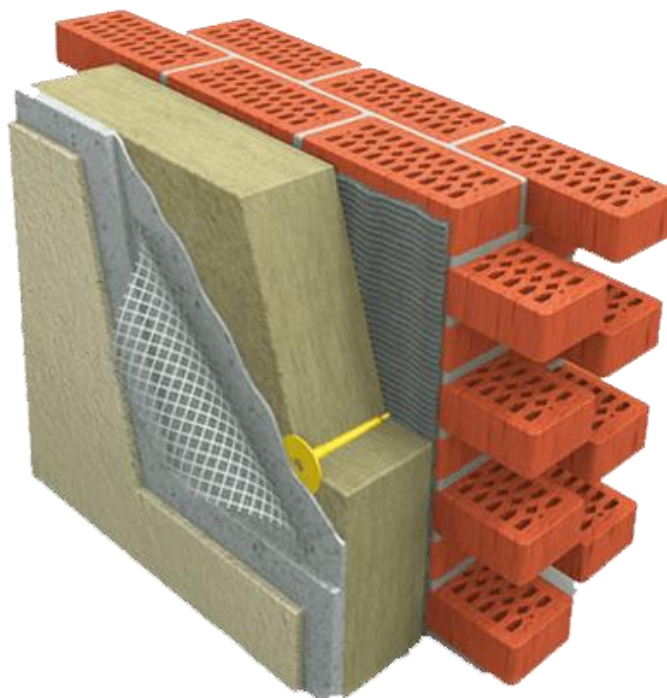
Розріз конструкції зовнішніх стін із фасадною теплоізоляцією та опорядженням штукатурками
